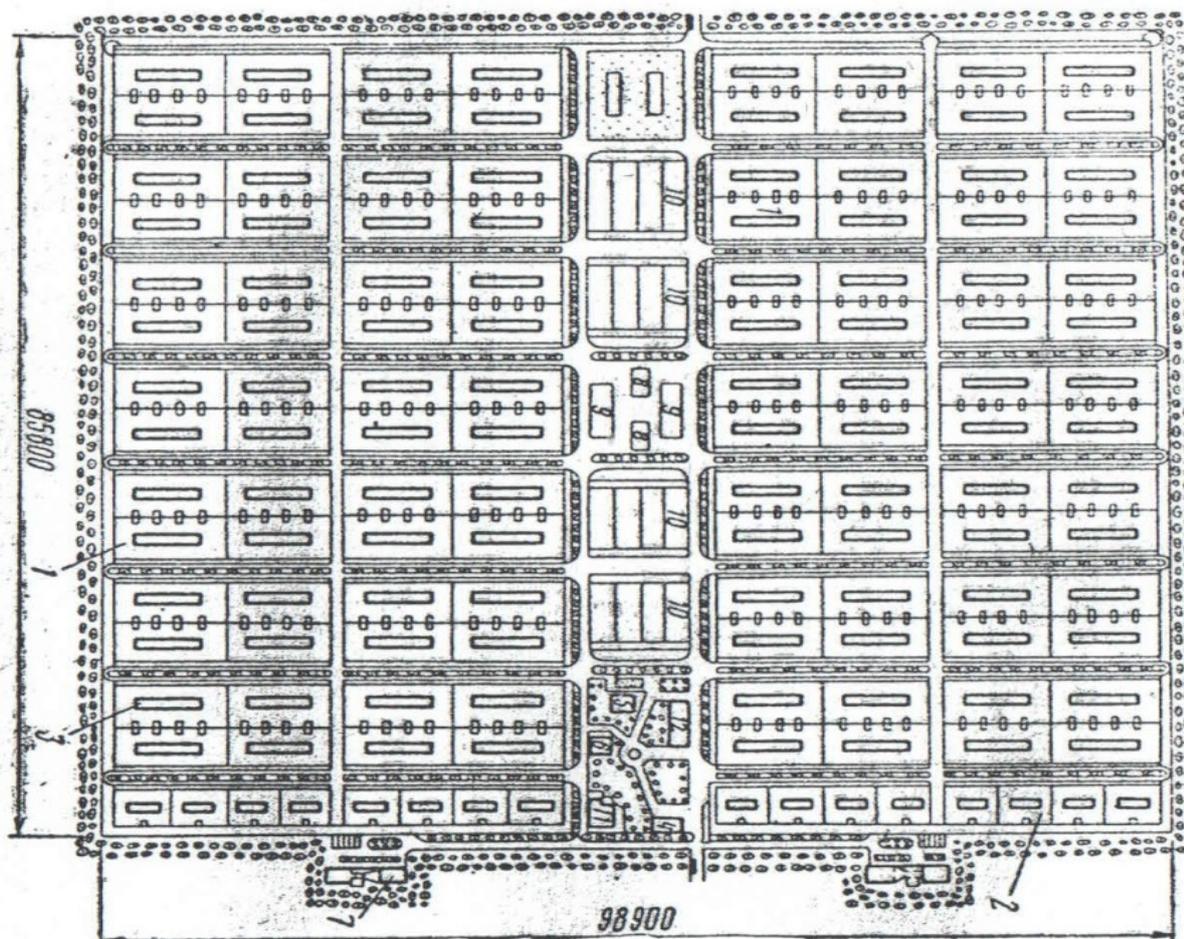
План открытой площадки на 30 тыс. голов скота:
